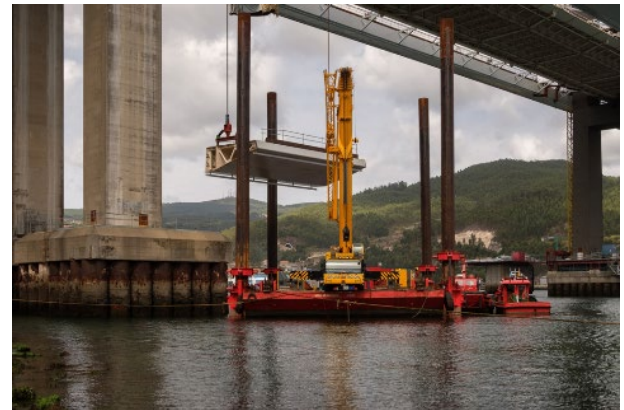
Detalle de izado de dovela lateral lado Sur desde pontona
